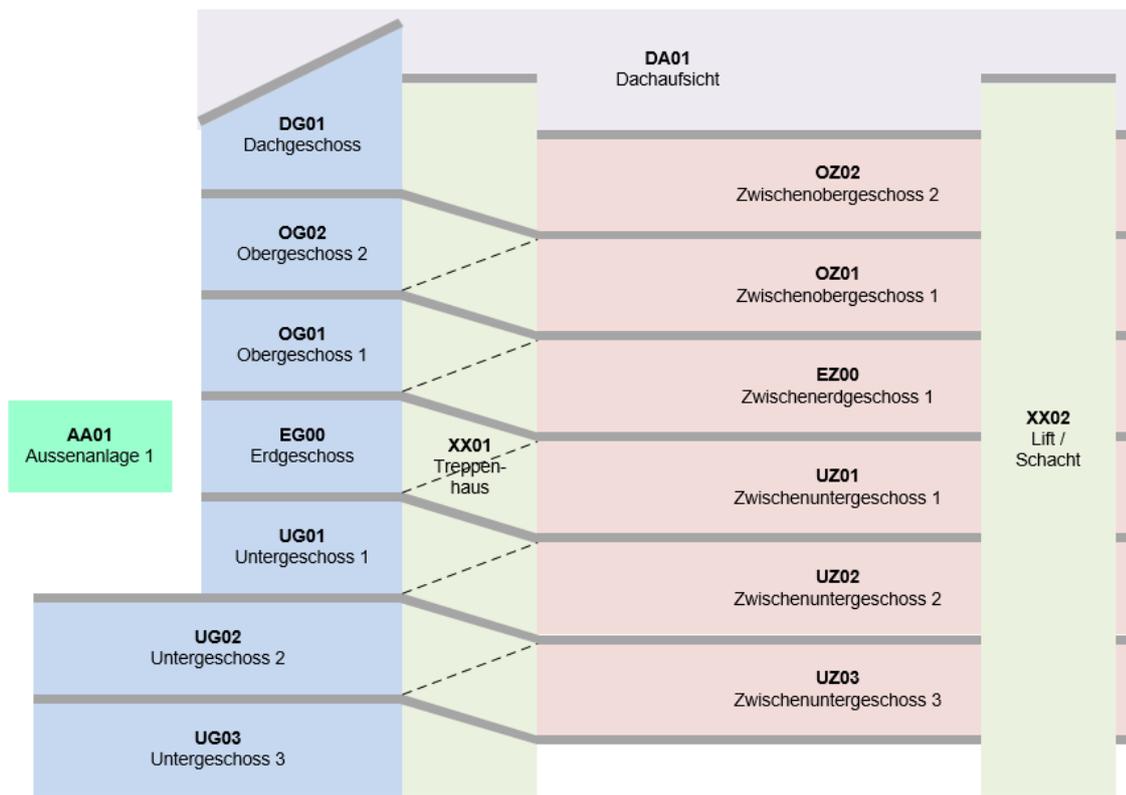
Bezeichnung Geschoss-, Treppenhaus/Schacht und Aussenanlage
